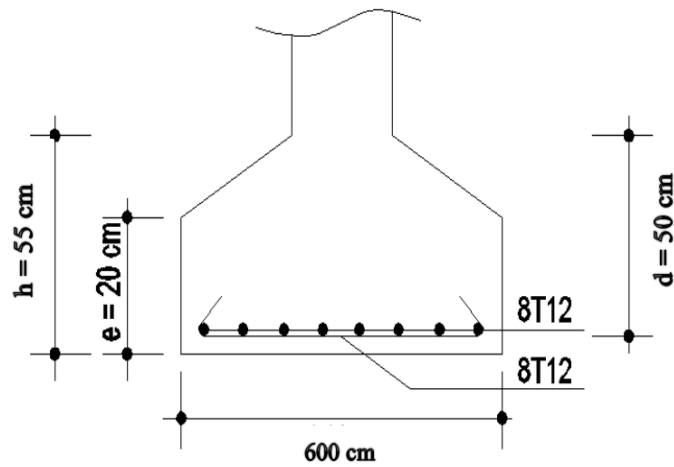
Schéma de ferrailage de la semelle isolée (HEA240).
